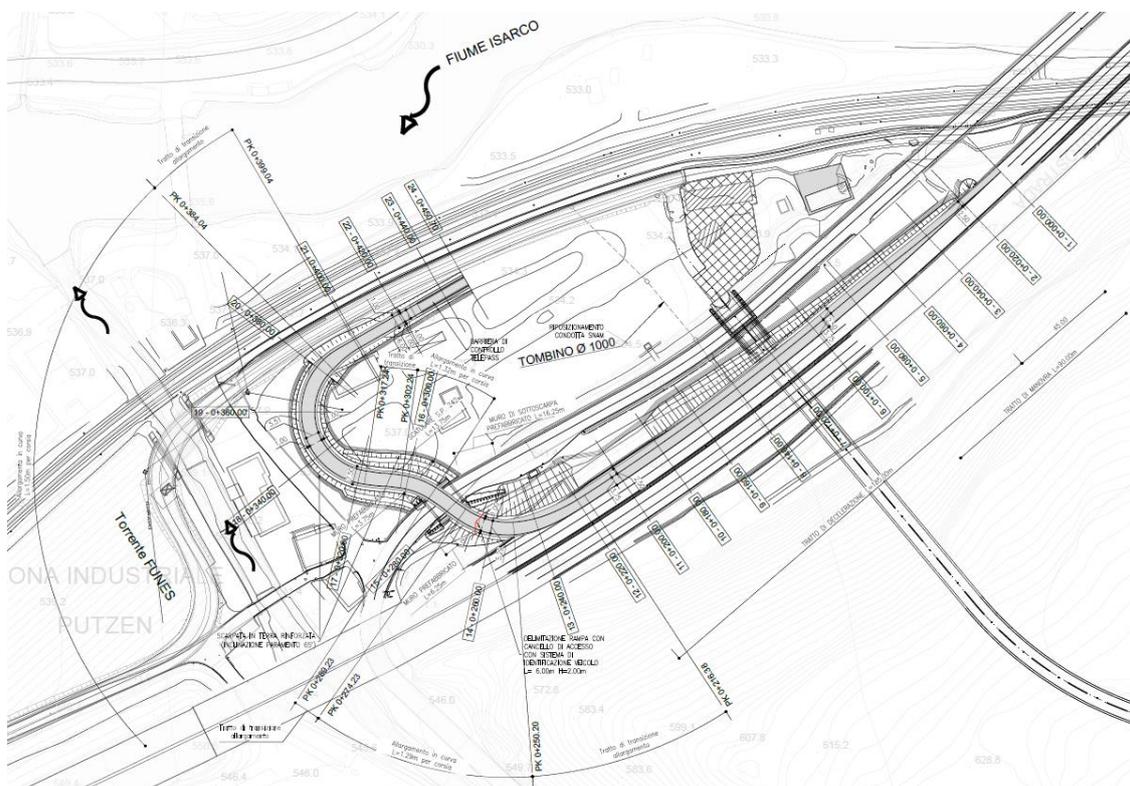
Planimetria d'intervento dell'uscita dall'autostrada A-22 per l'accesso all'area di Funes
